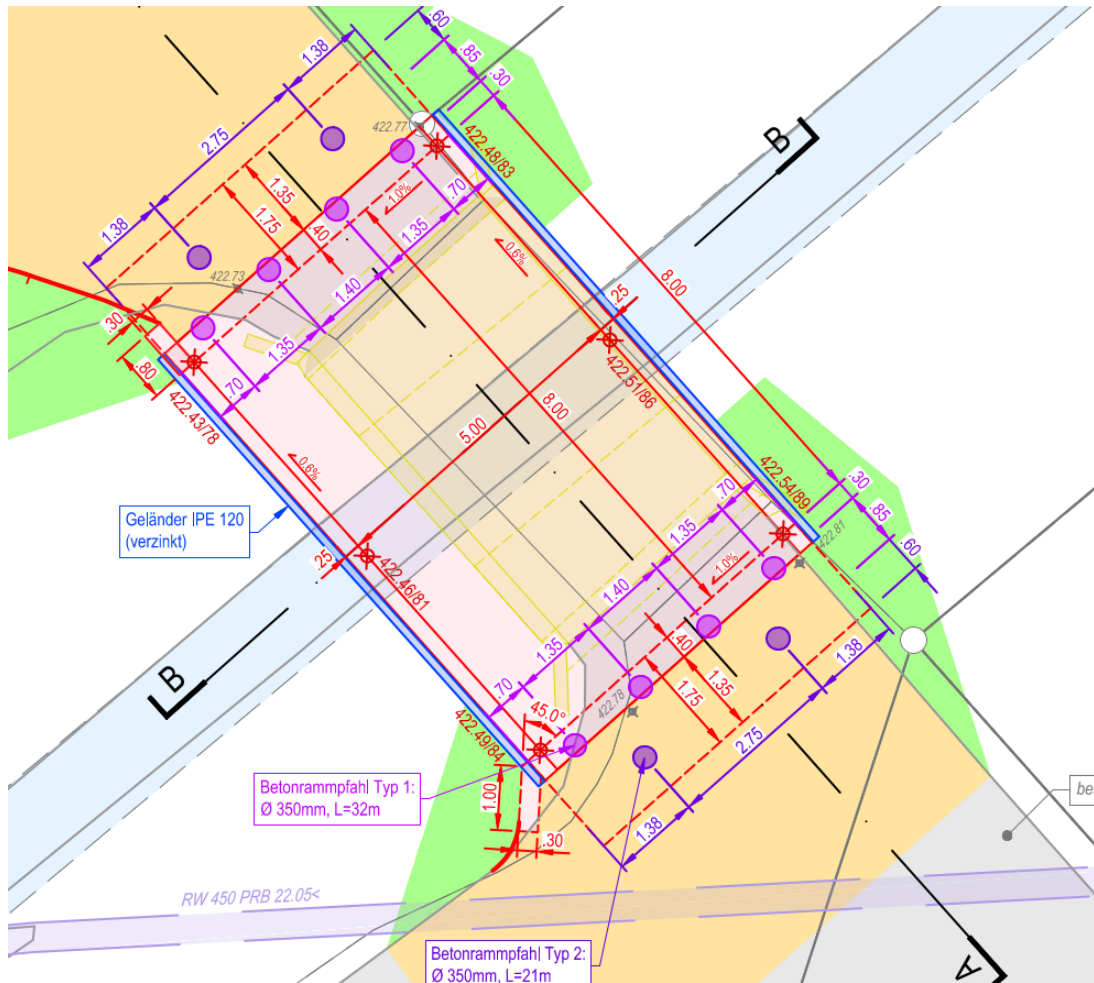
Ausschnitt Projektplan, Situation Brückenplatte
